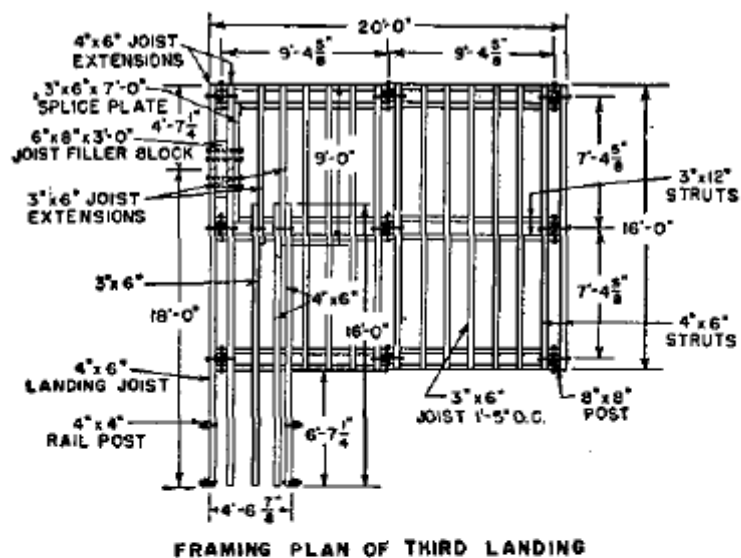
Protiletadlová věž – pohledy, konstrukční detaily (pokračování)
